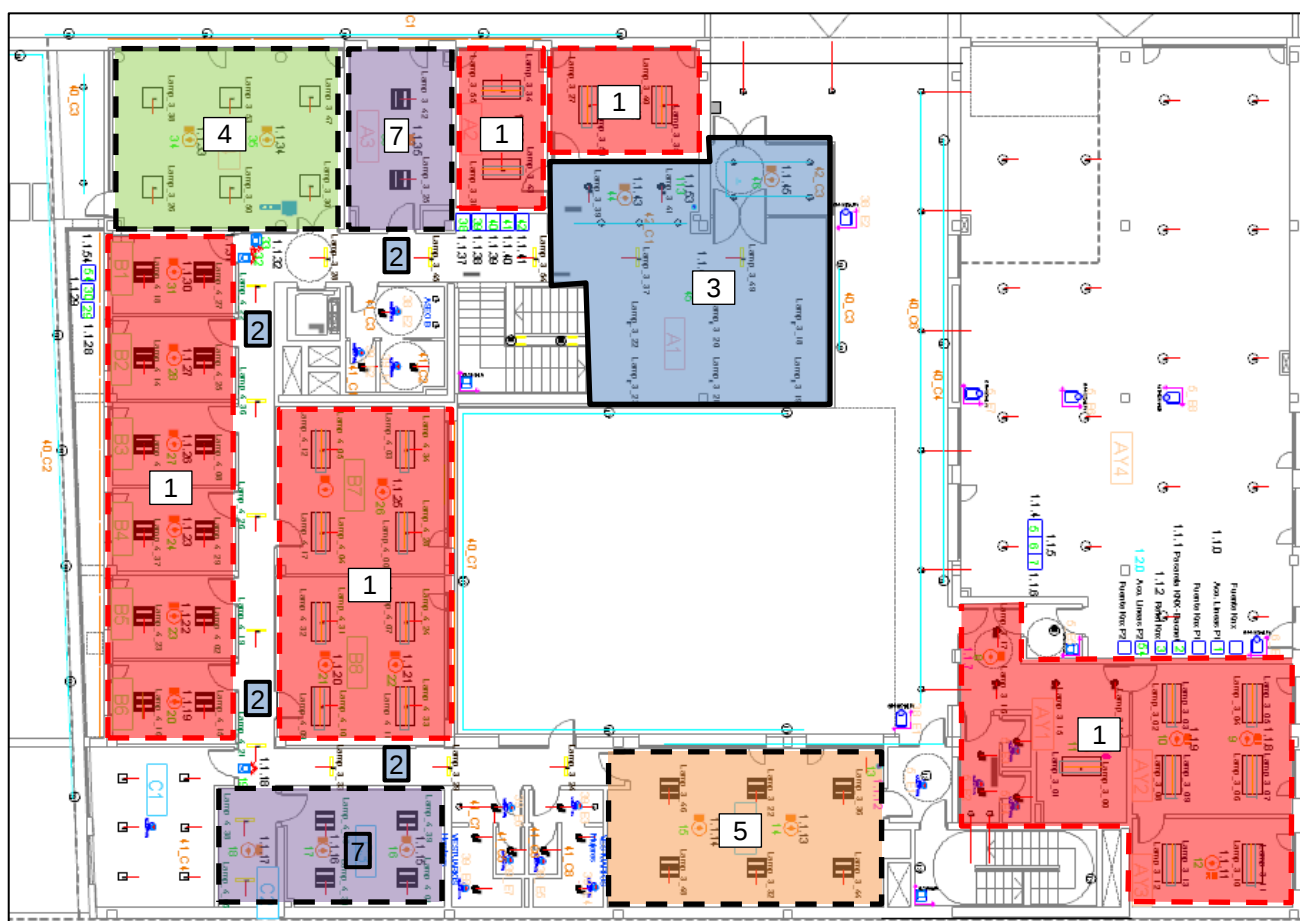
Planta Baja. Zonas actuadas con KNX
